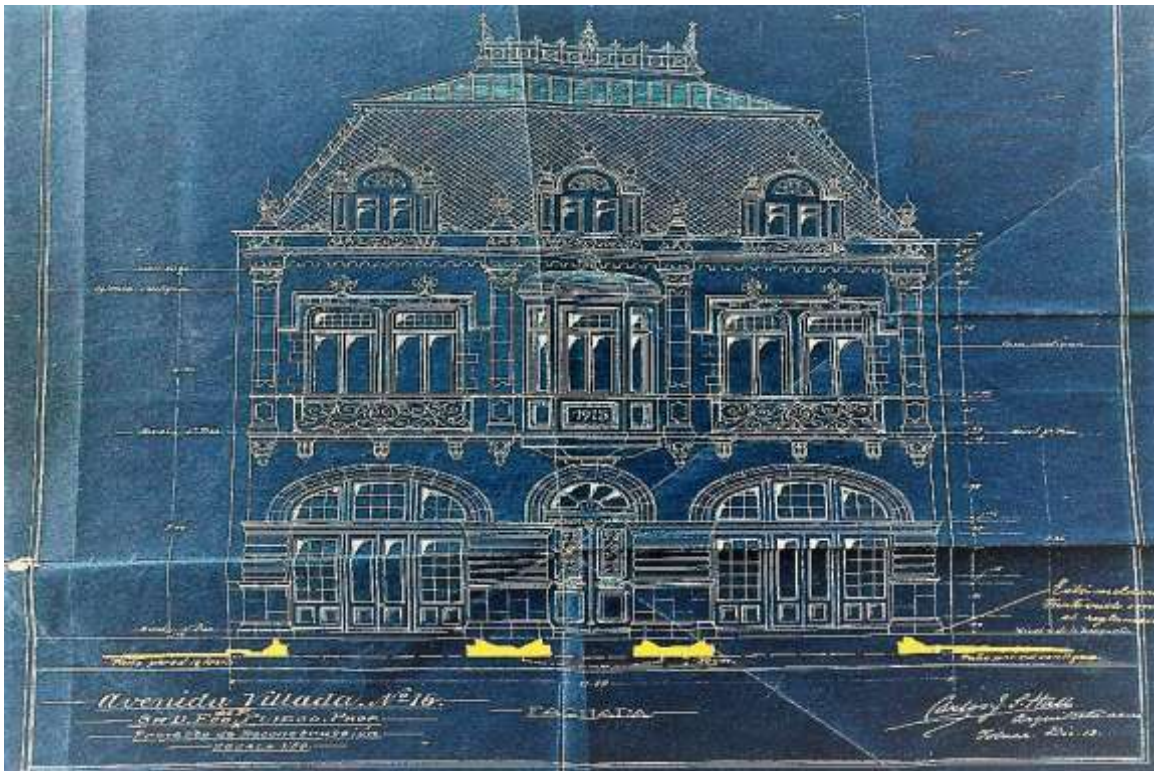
Fachada de la casa n.111 de la Avenida J. V. Villada
